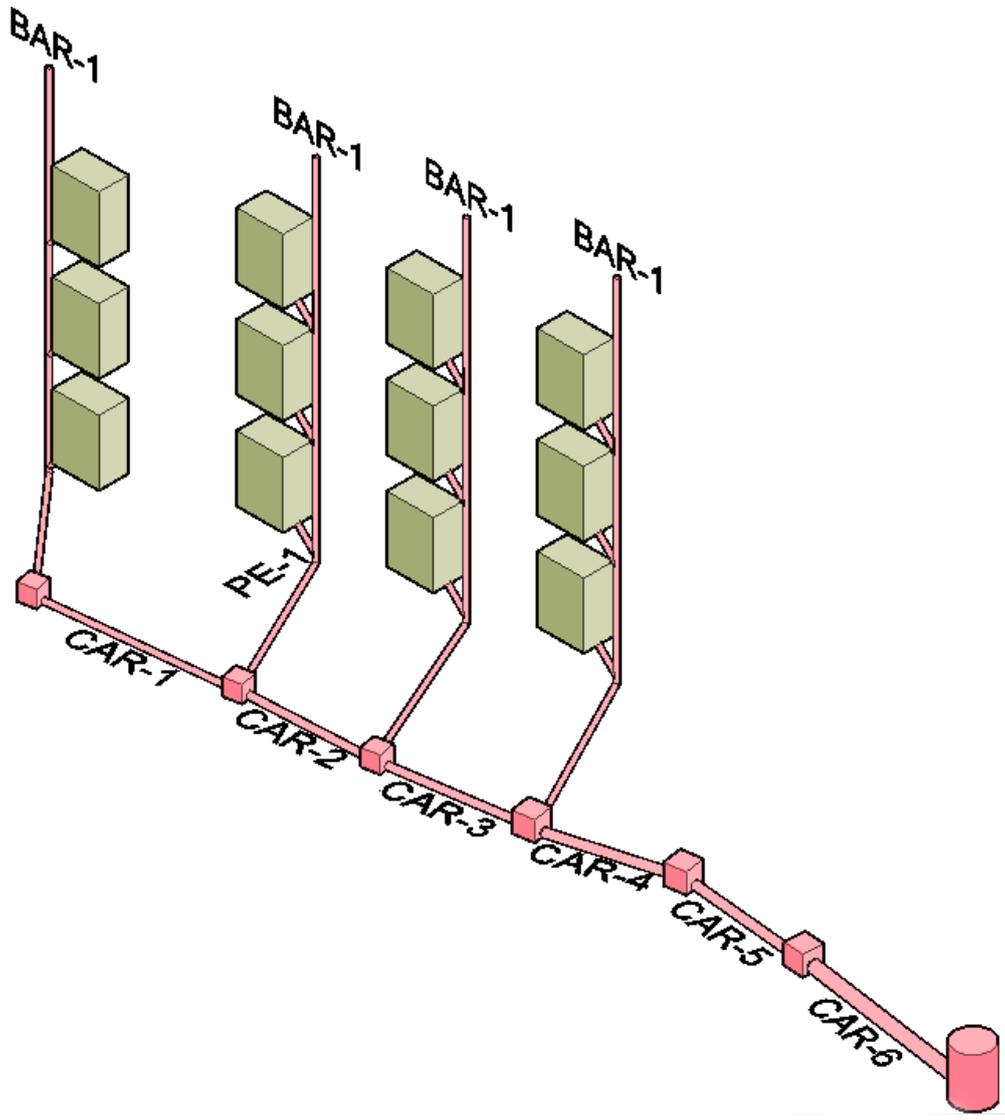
Esquema con las descargas de los cuartos húmedos lazo derecho
